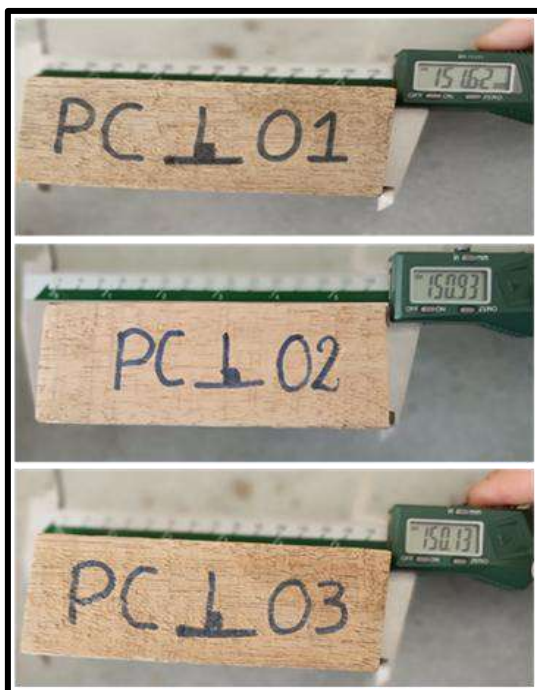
Dimensiones de probetas previas al ensayo de compresión perpendicular
